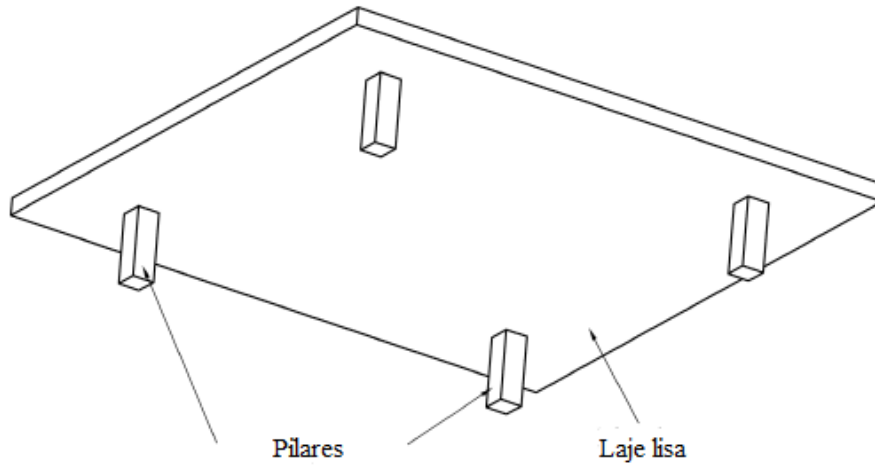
Sistema de laje lisa (SAHAB *et al.*, 2005, p. 313)
